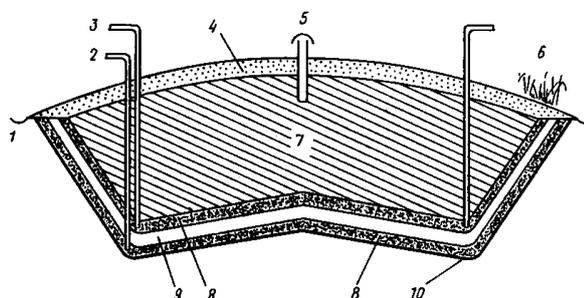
Схема безопасной свалки с двойной системой покрытия нижнего основания [6]: 1 – сливная канава; 2 – система контроля за утечками; 3 – удаление жидкости; 4 – грунтовое покрытие; 5 – газовая вентиляция; 6 – растительность; 7 – опасные отходы; 8 – проницаемый слой; 9 – непроницаемый слой; 10 – мембрана покрытия
